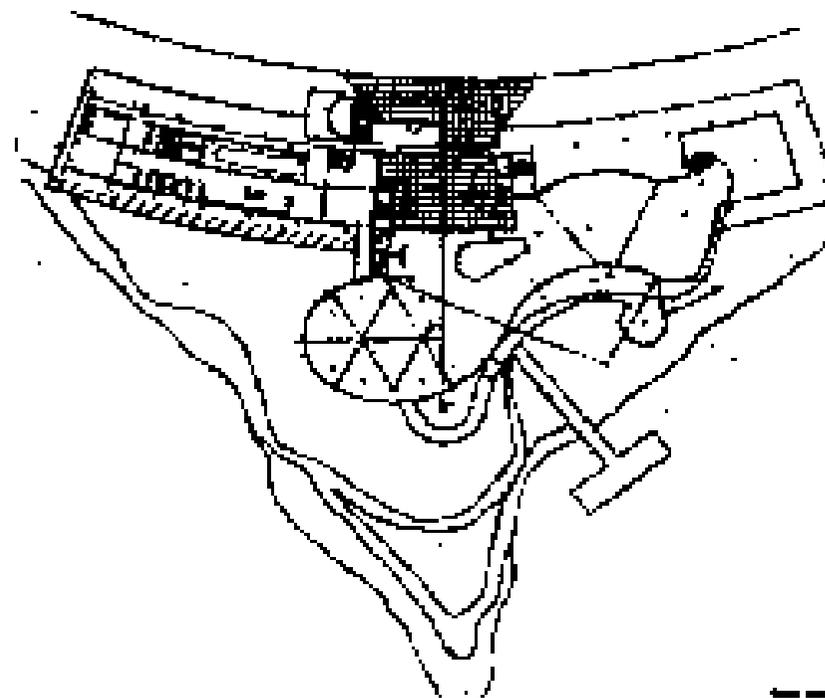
Planta baixa do térreo Hotel da Pampulha. Fonte: Stamo Papadaki, 1951, p104/7.
